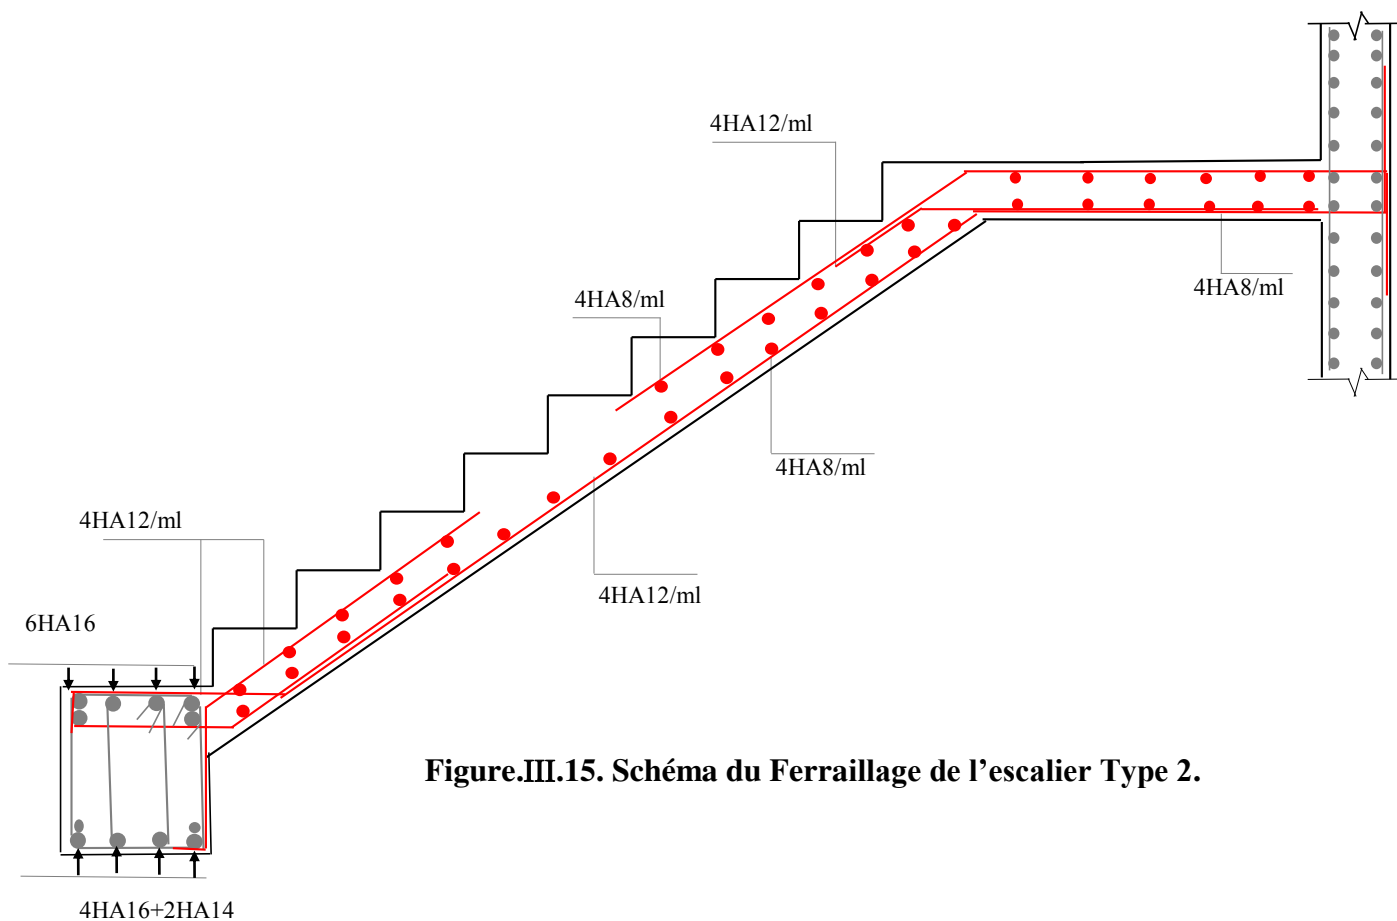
Schéma du Ferrailage de l'escalier Type 2.
